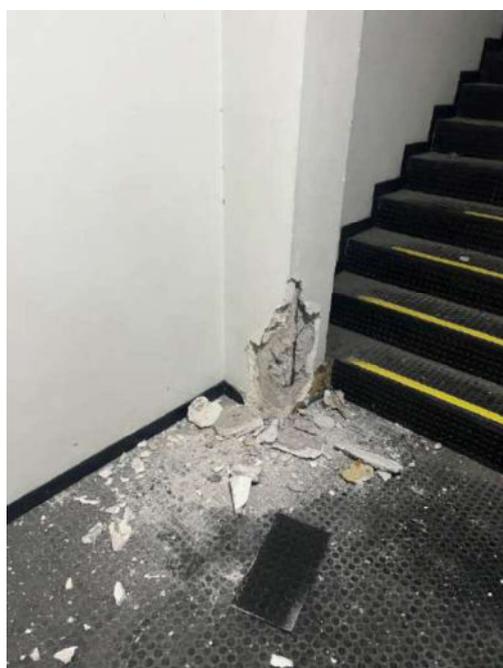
Corrosão da armadura no pilar 56 da escada do pavimento subsolo (garagem)
